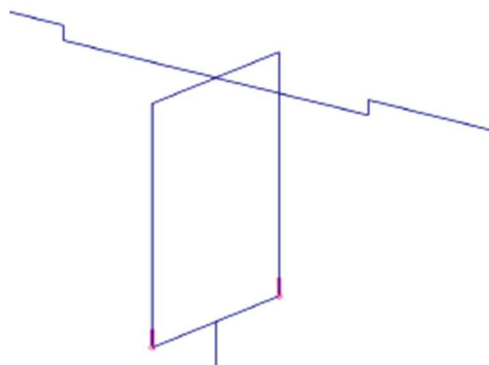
Pormenor da inserção do tabuleiro num dos pilares
